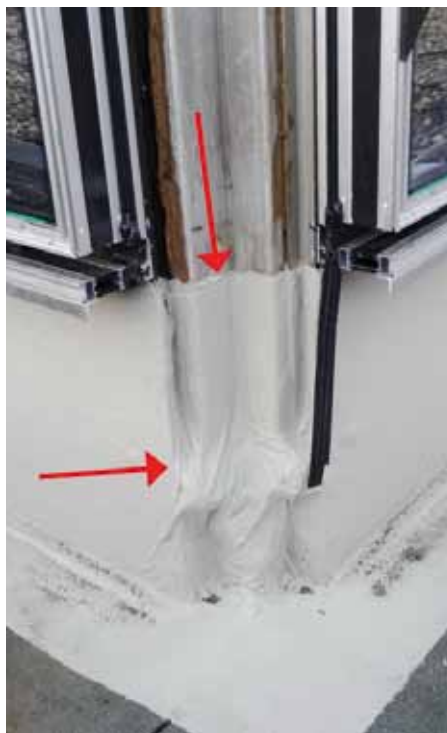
Anschluss mit FLK ohne Klemmprofil – Eckausbildung
